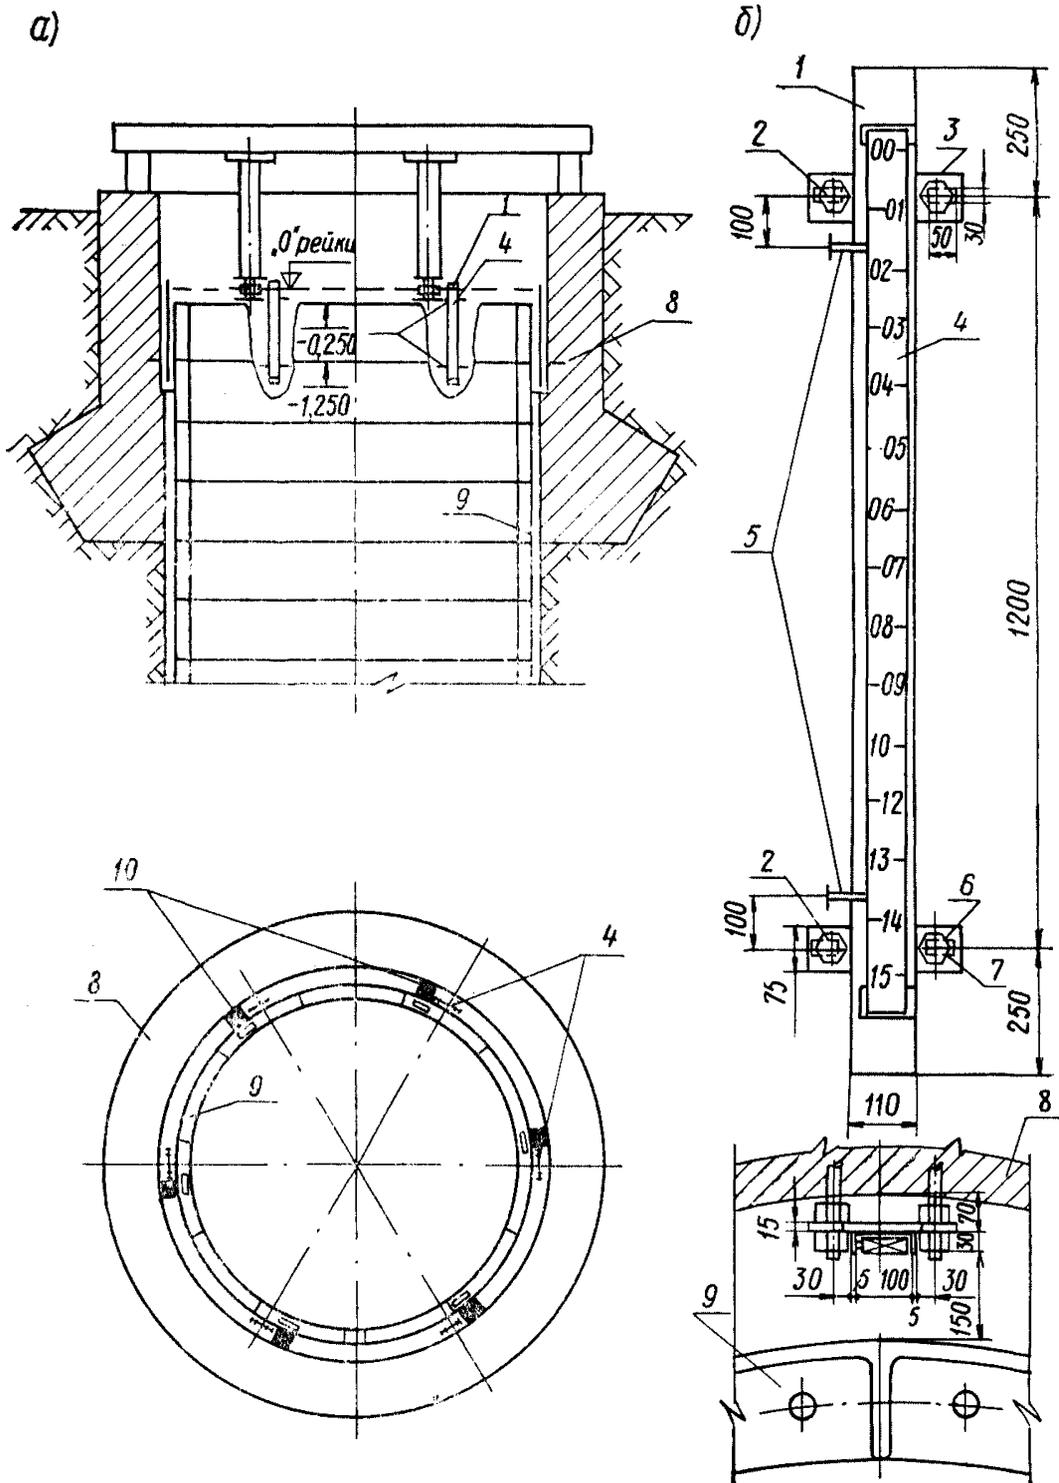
Схема установки (а) и конструкция (б) визирных реек:
